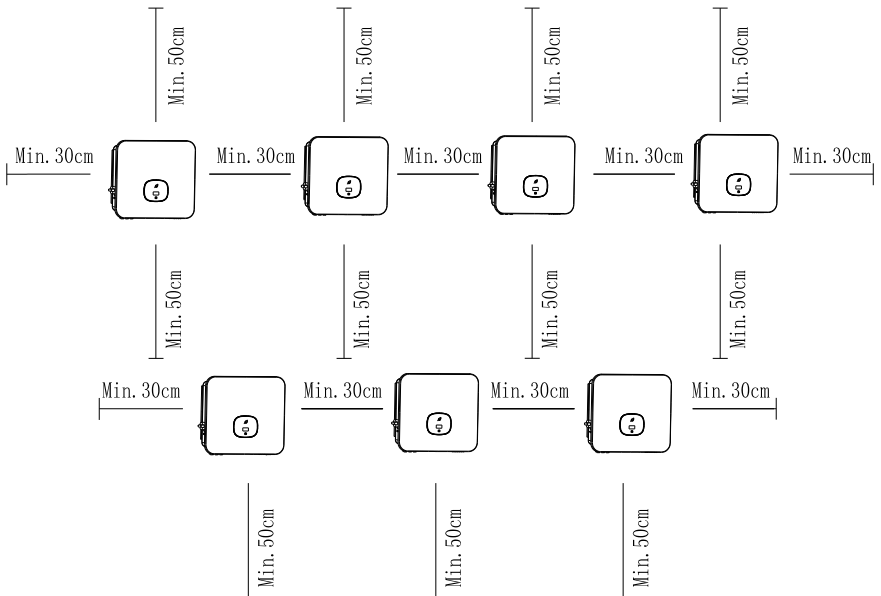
Installationsdimensionen mehrerer Wechselrichter
